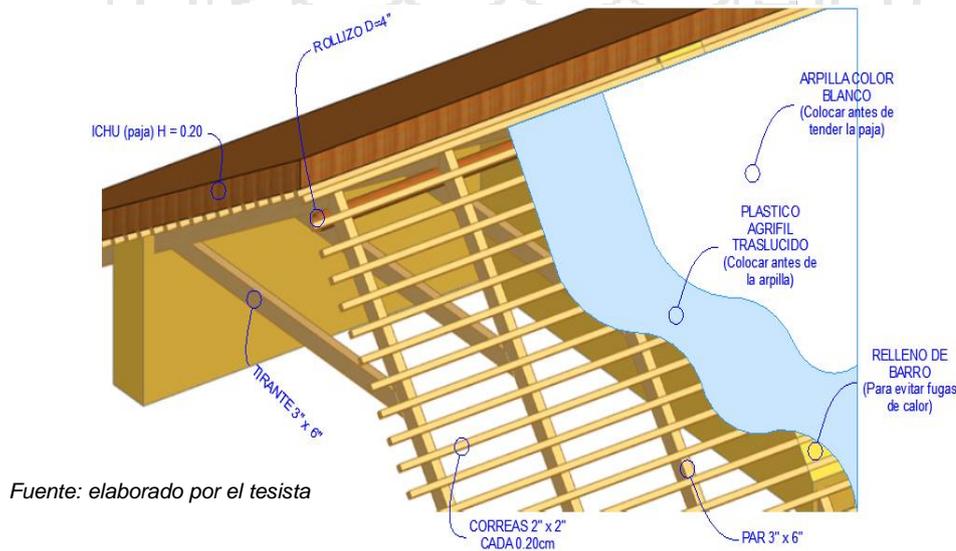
Vista tridimensional de techo inclinado.
